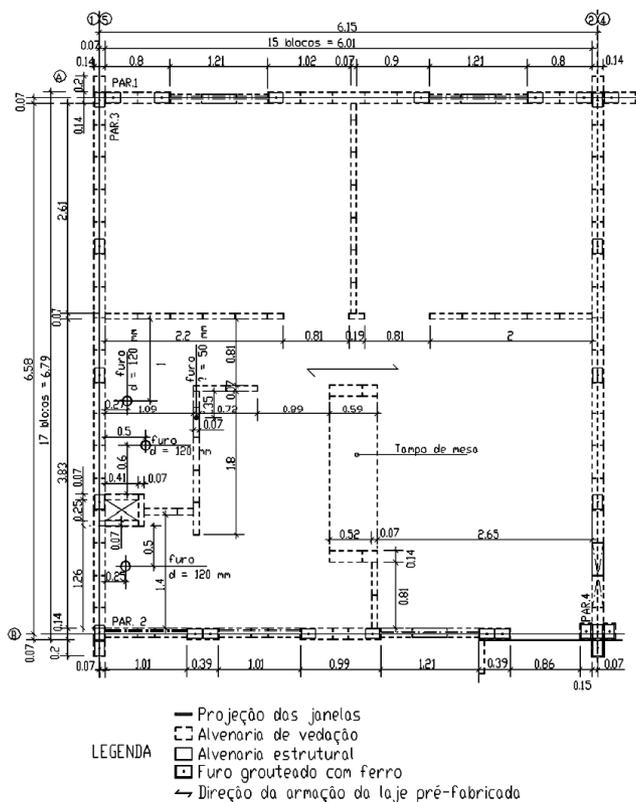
Material referencial - planta 2, apartamento padrão VG.22-A
